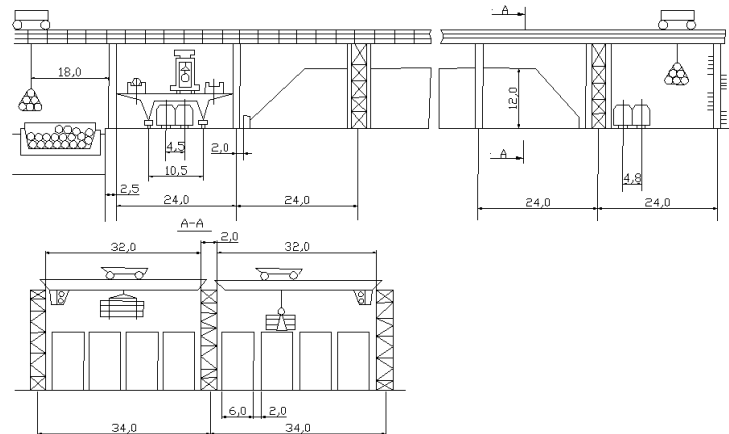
Схема механизации перегрузки леса с мостовыми кранами на эстакадах
